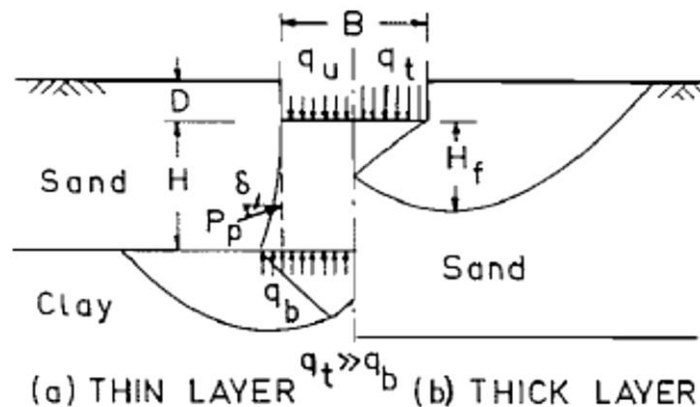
Mécanisme de rupture d'une fondation sur un sable dense recouvrant une argile molle (Meyerhof 1974).
